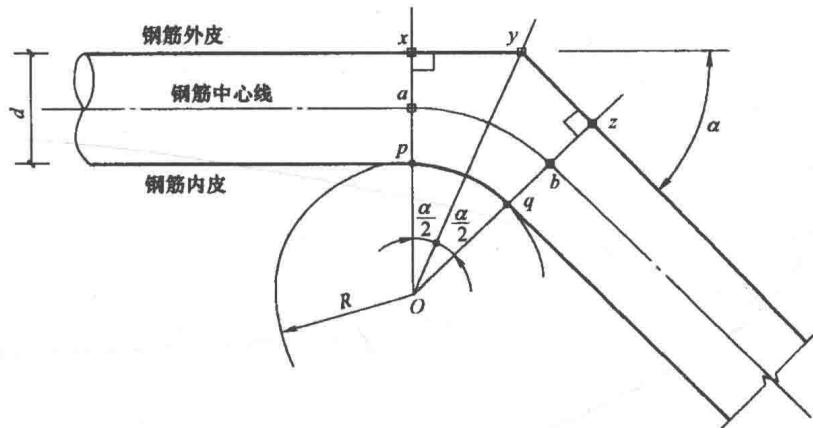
小于或等于 90° 钢筋弯曲外皮差值计算示意图
